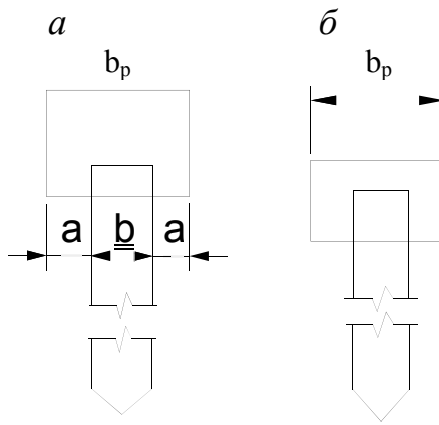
К расчету ширины монолитного ростверка свайного фундамента
